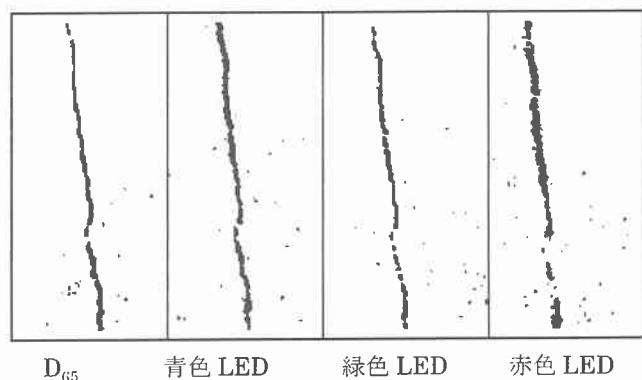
ひび割れ抽出画像の光源の差による影響
